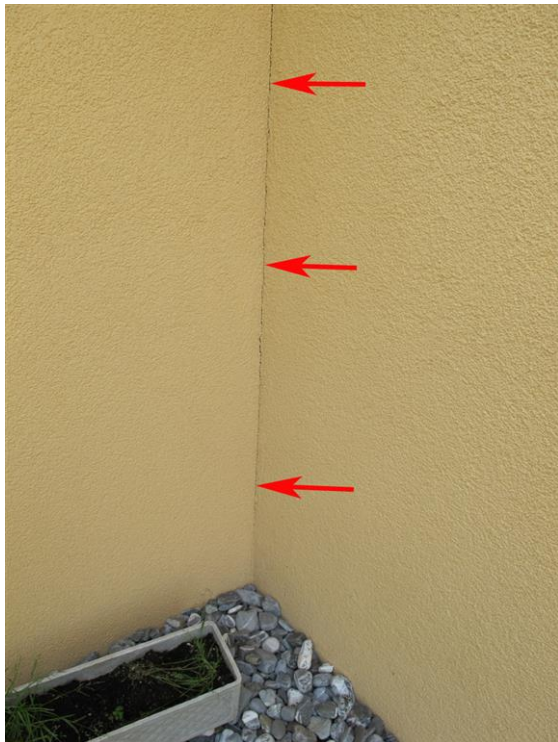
IMG_0019.jpg / Aussen Fassaden / Nord
